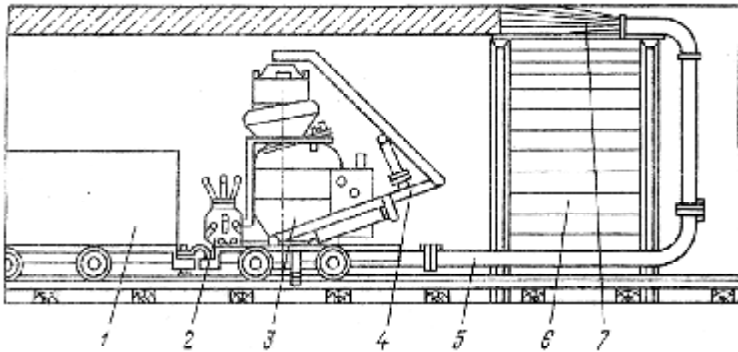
Зведення бетонного кріплення комплексом БУК-3:
